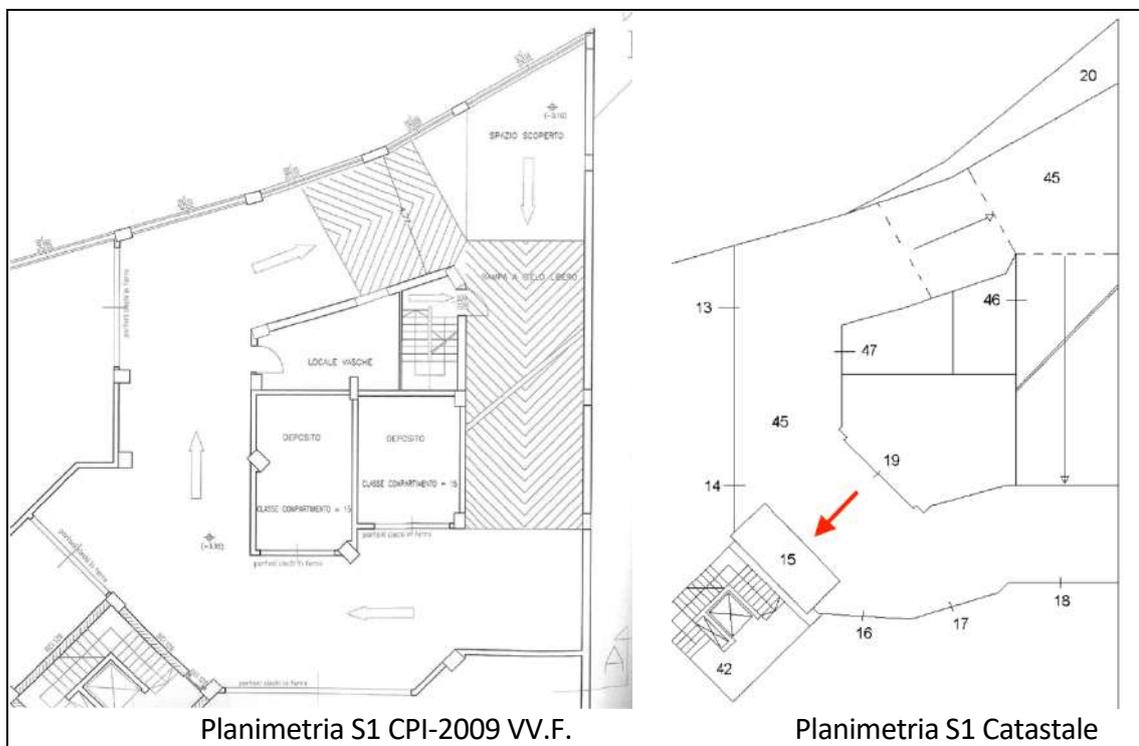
Localizzazione posto auto sub 15 nell'estratto dell'elaborato planimetrico catastale della particella 260 foglio 51 di Paternò (via Stazione 11 piano 1° sotto-strada).
